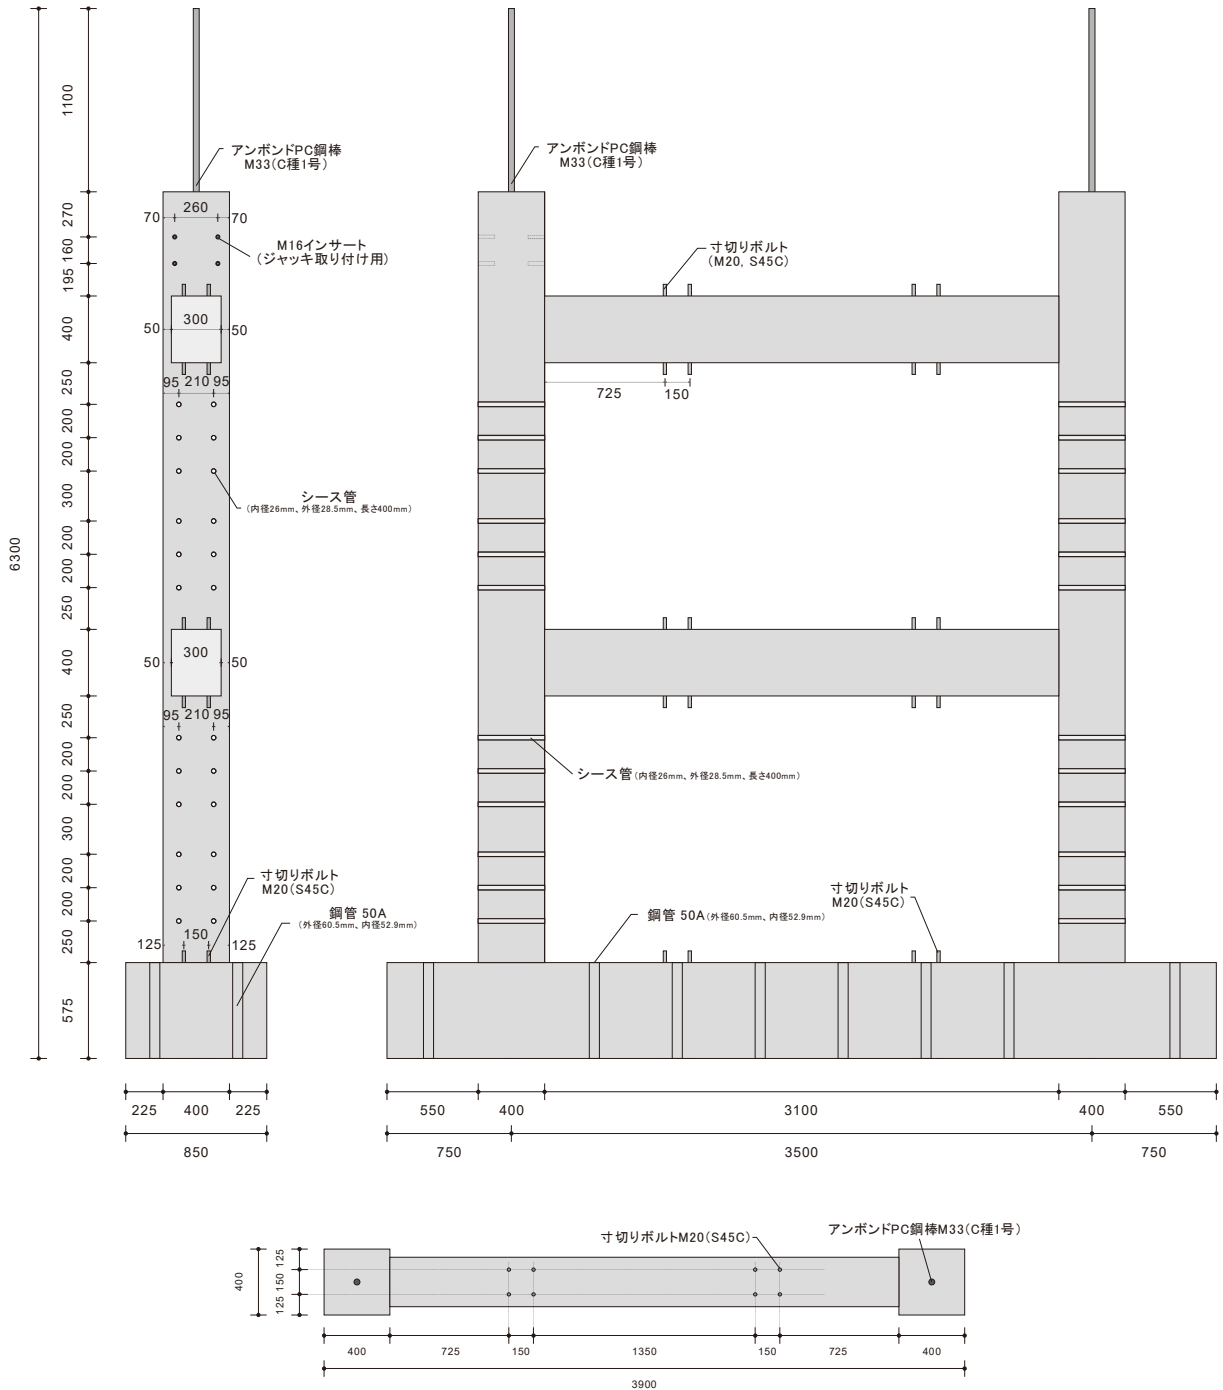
試験体 WA の RC 部分の寸法図 (単位:mm)
